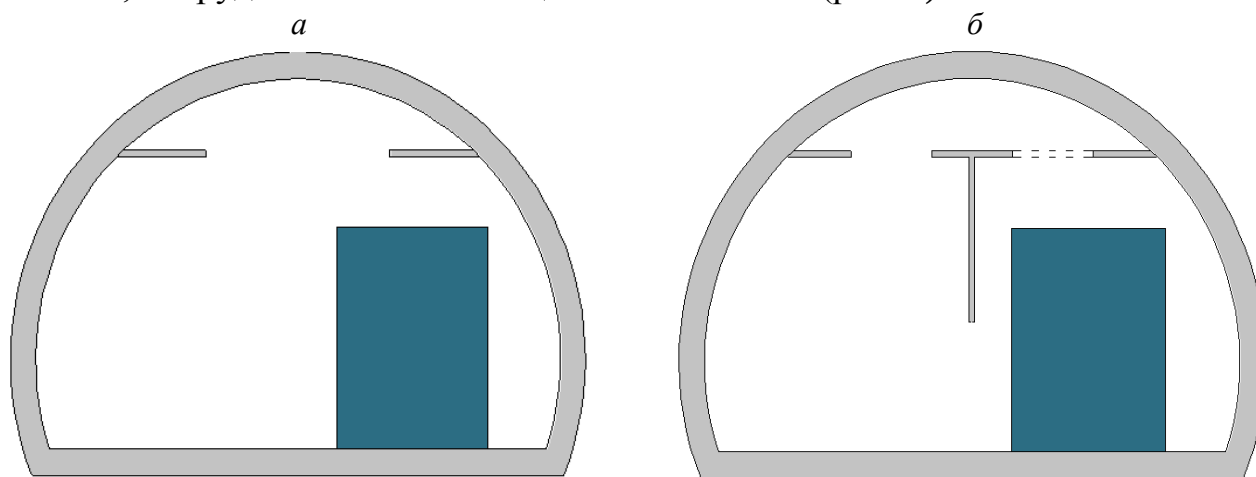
Двухпутный тоннель: *а* – с вентиляционным отсеком; *б* – то же с продольной перегородкой, разделяющей сверху объем путевого отсека
